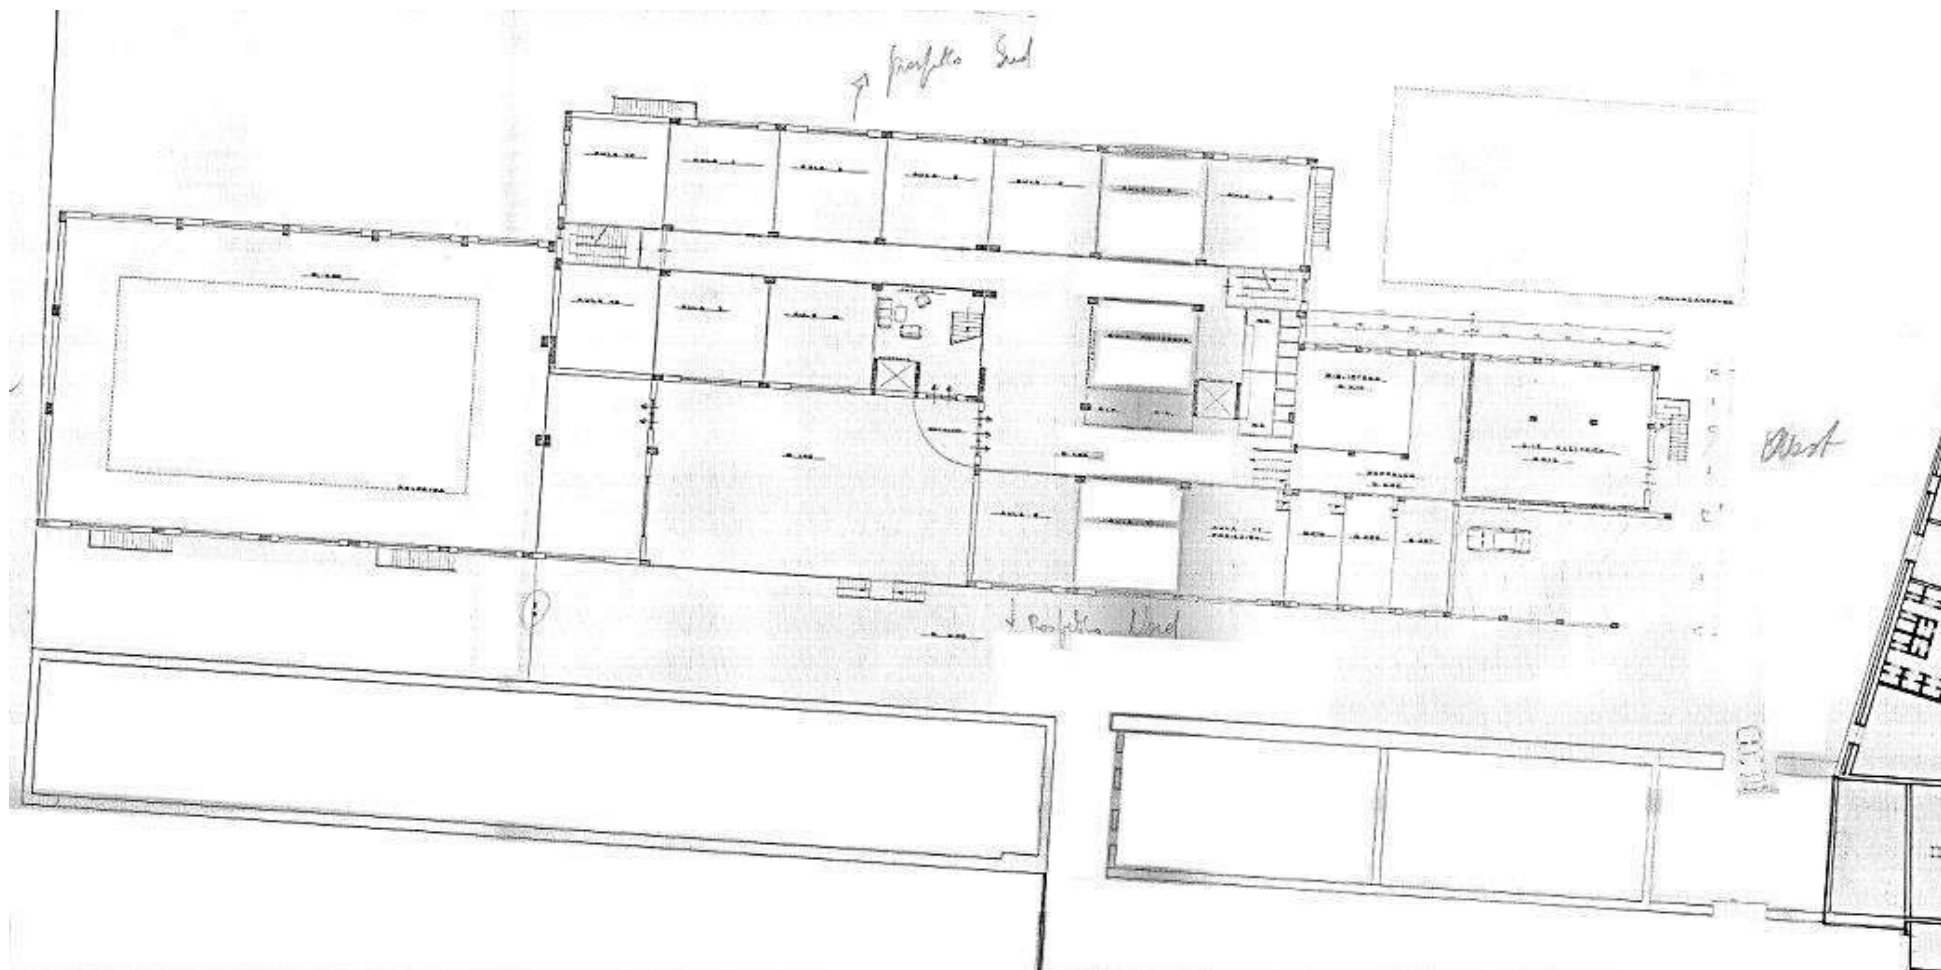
1984, Pianta della caserma Avogadro e Planimetria generale di progetto dei lavori del IV lotto
